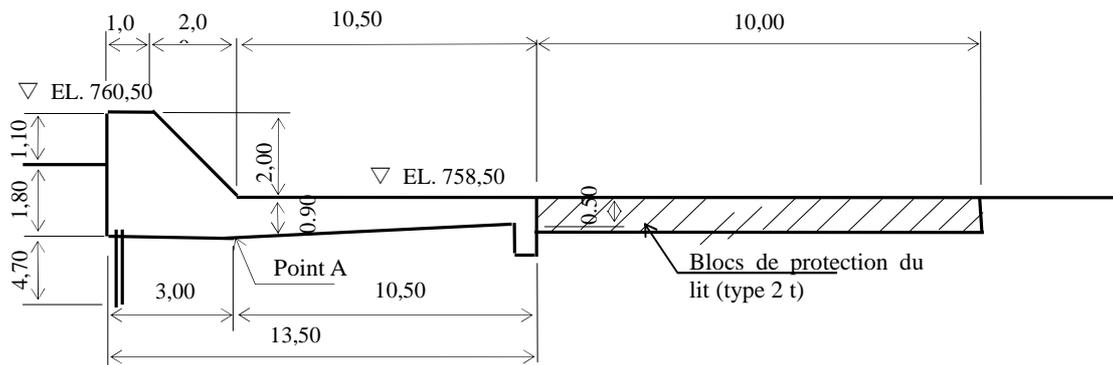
Plan en coupe du barrage fixe du déversoir de sécurité
